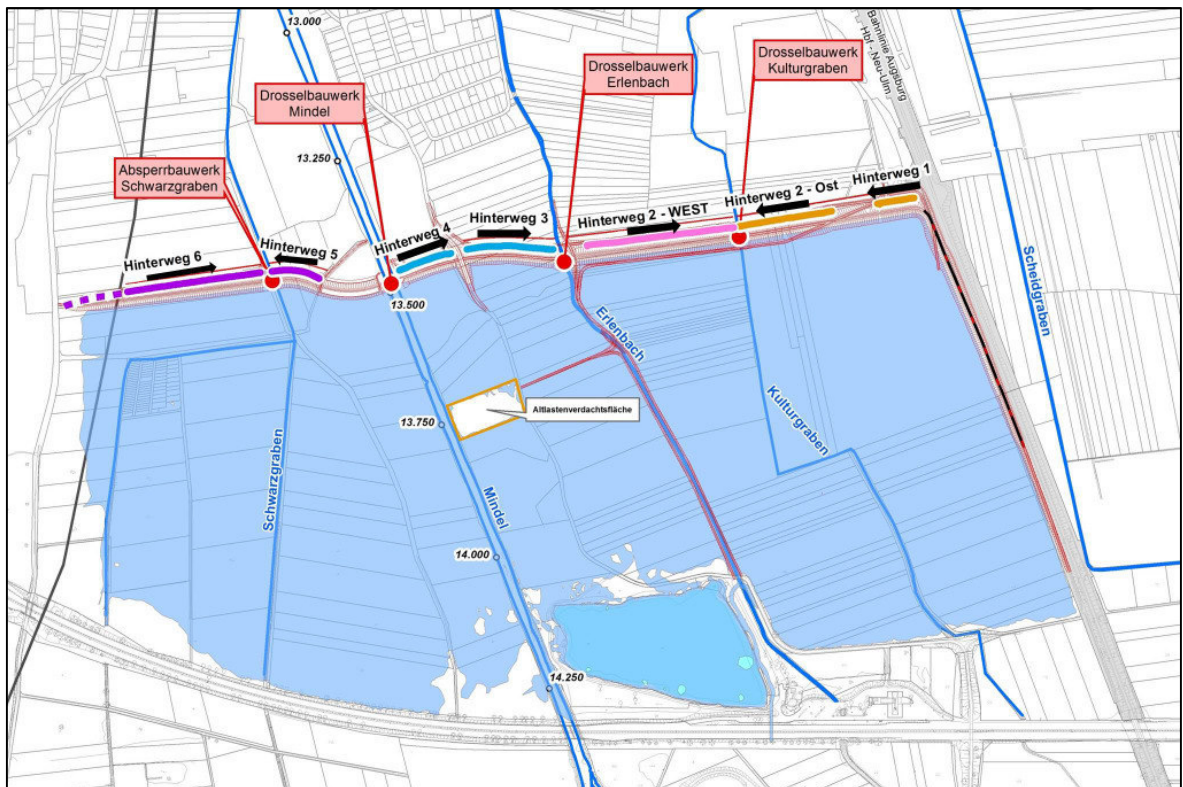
Lageplanausschnitt HRB mit Lage und Bezeichnung Drännagegräben
